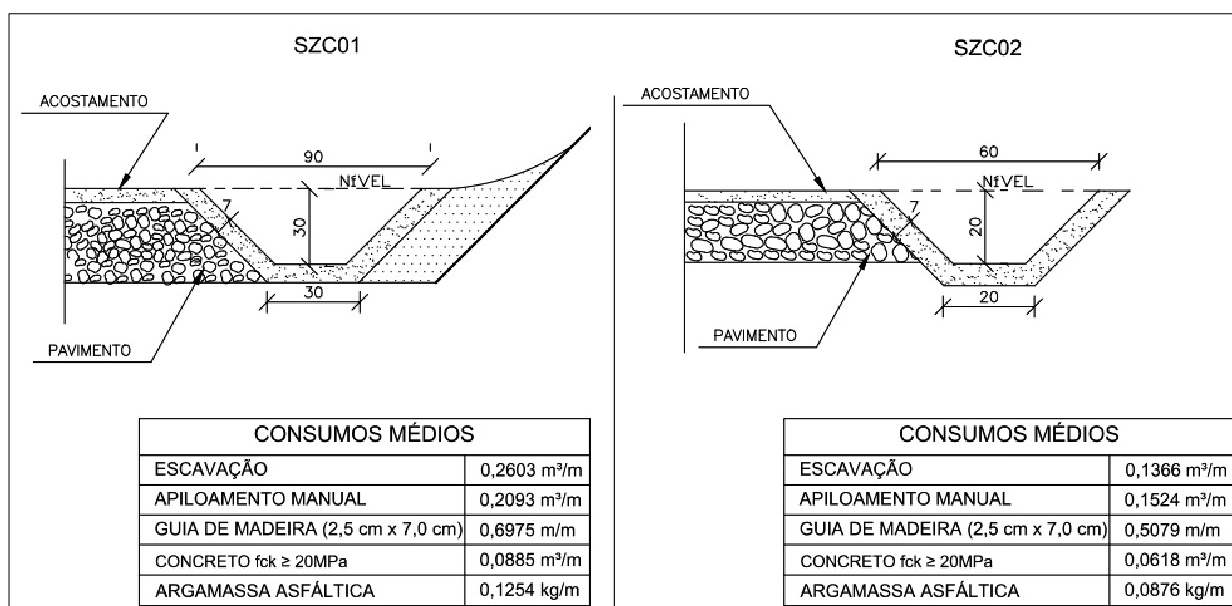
Sarjetas Trapezoidais de Concreto (DNIT, 2018).
